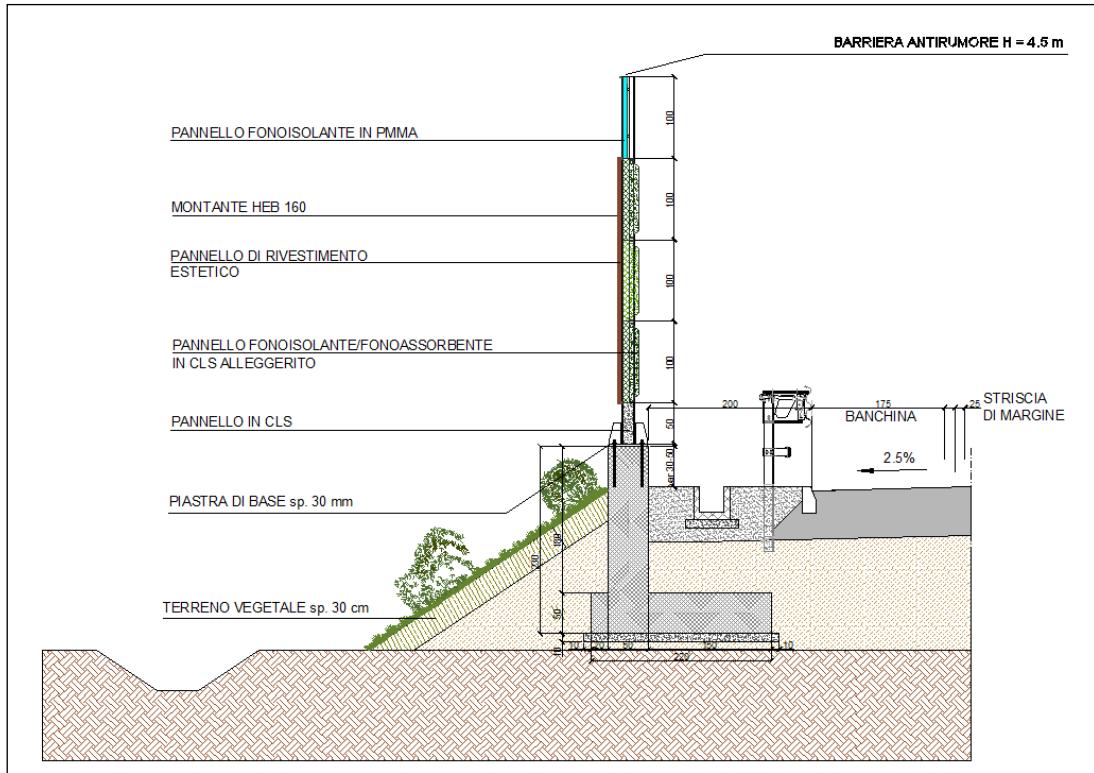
SEZIONE TIPO BARRIERA H 4,5 M
